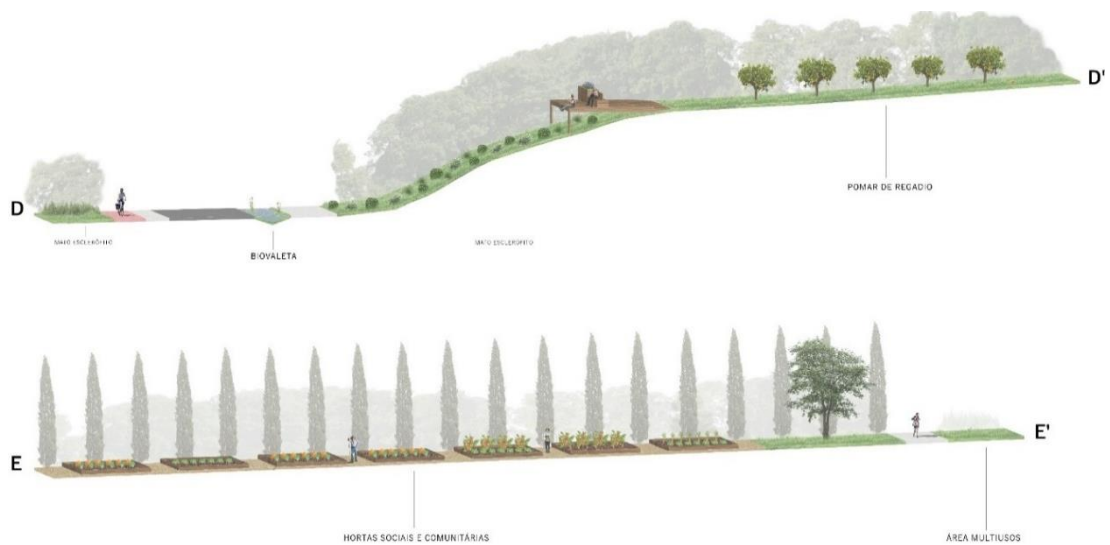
Cortes, DD' e EE' – Anexo 16 (Autor)
